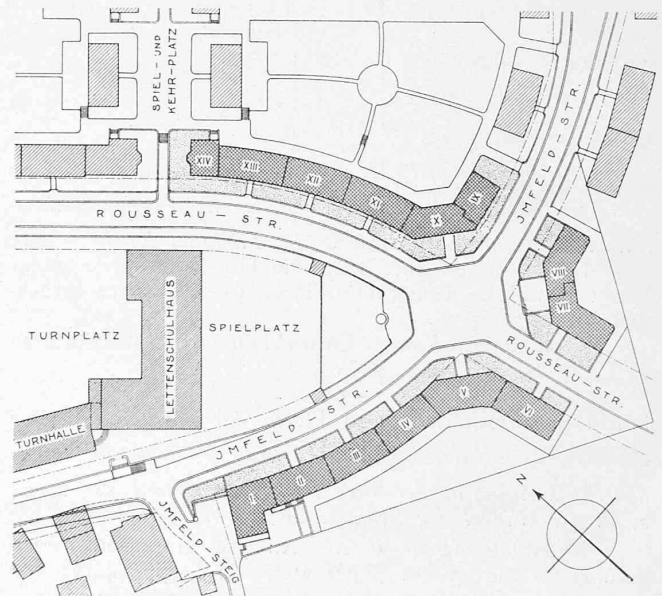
Lageplan der Wohnkolonie im Letten. — Masstab 1:2000.
